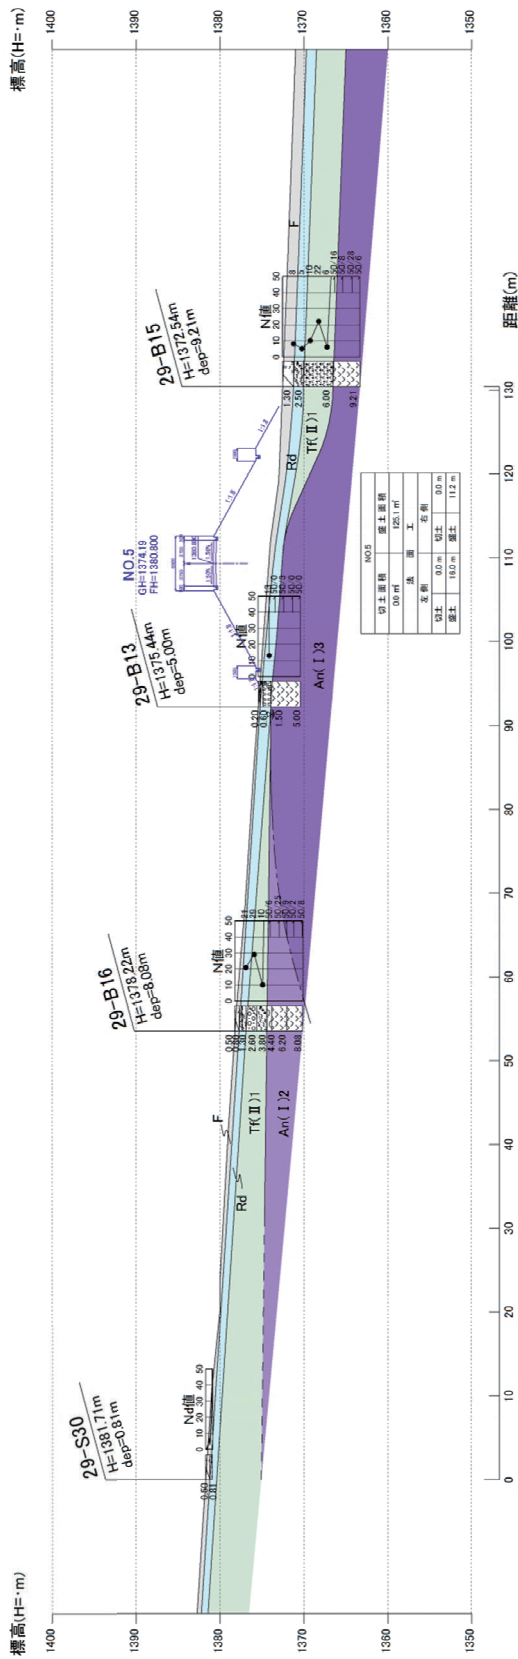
(1) 推定地質断面図 (盛土箇所) 調査位置平面図
